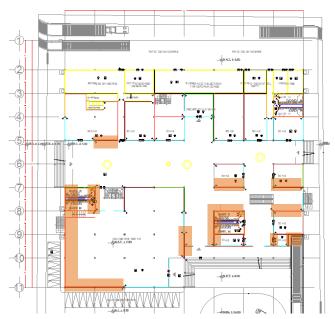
Ubicación en el plano de muro bajo con ventana en Planta Baja
